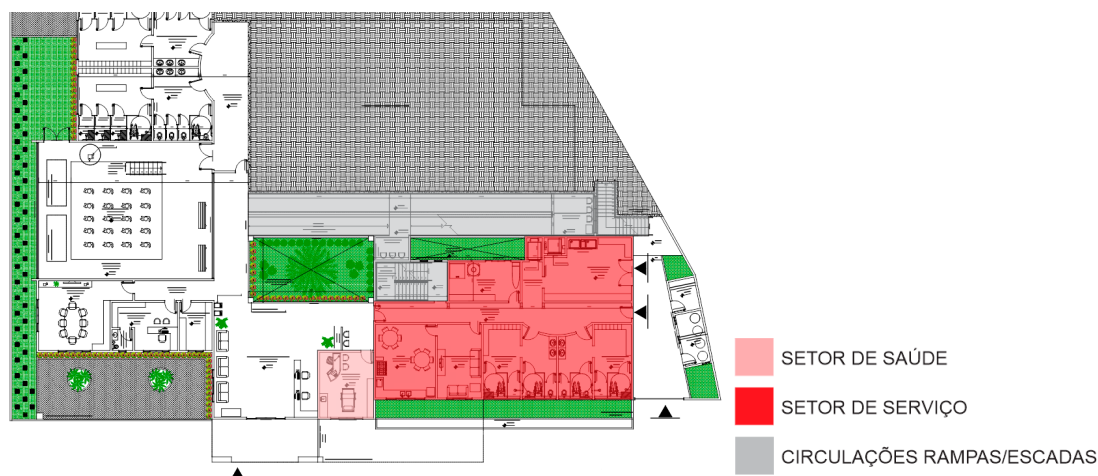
Planta Baixa do Setor de Serviços, Saúde e Instalações.
